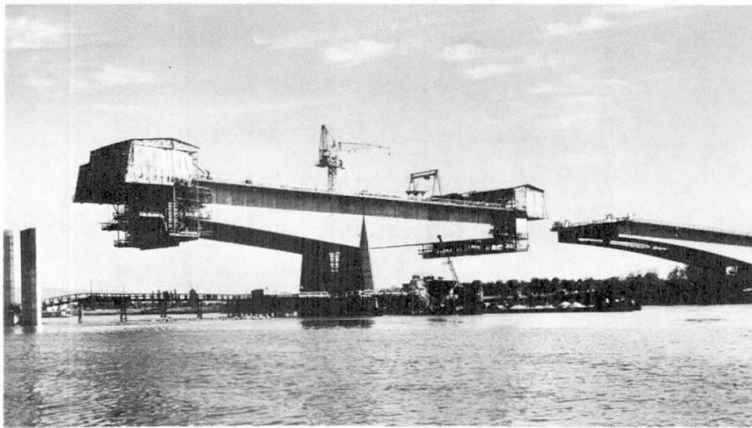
Rheinbrücke Bendorf – Freivorbau in Spannbeton
